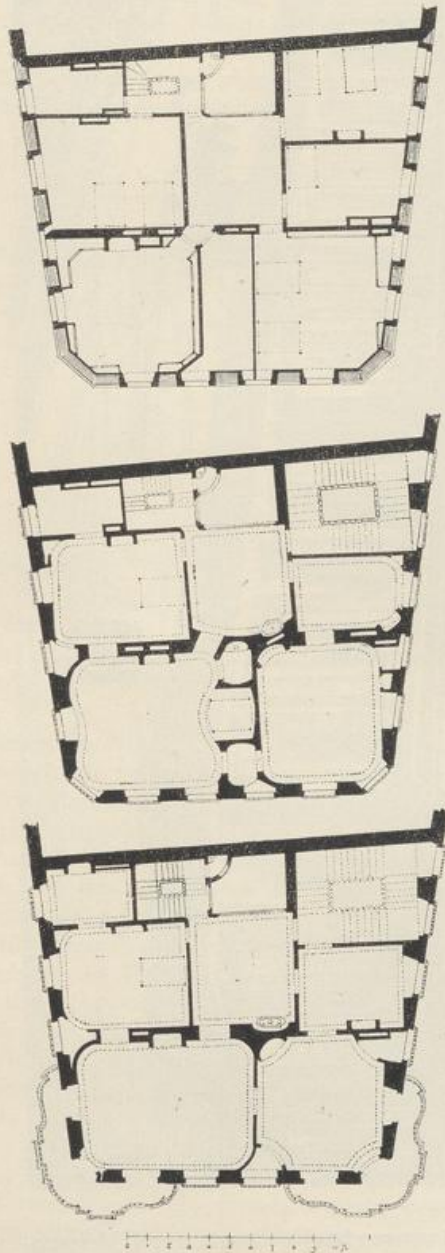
Grundrisse dreier Geschosse der *Maison Bréthous* zu Paris
